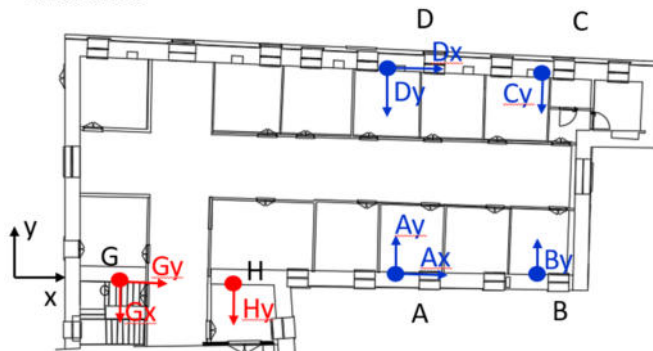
Disposizione accelerometri nel piano secondo dell'edificio.
